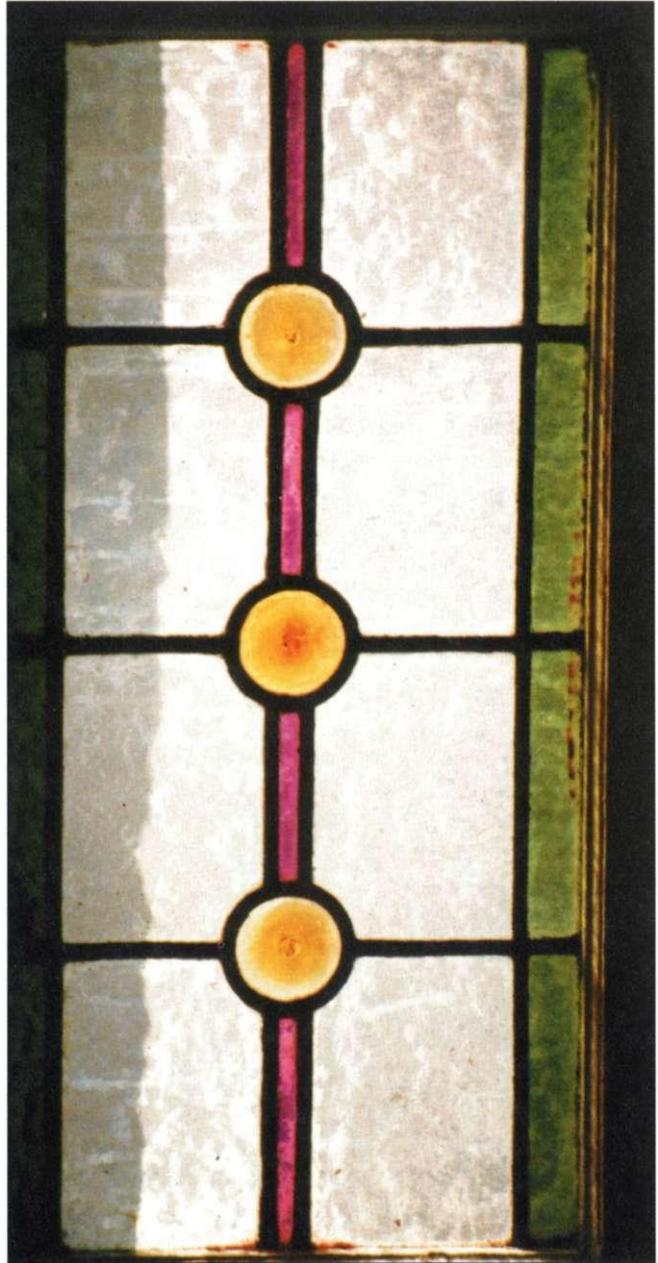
Wilhelm-Kobelt-Straße 8, Detail der Treppenhausfenster
